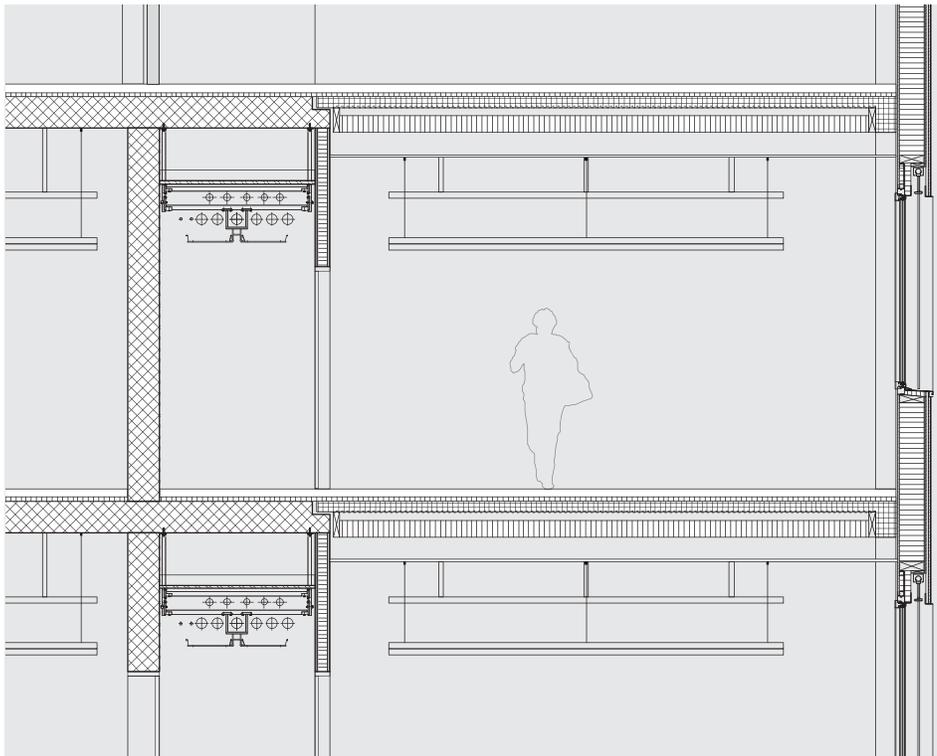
Konstruktionsschnitt eines Laborgebäudes in Neuenburg mit vorgefertigten Holz-Beton-Verbundelementen für die Geschossdecken sowie vorgefertigte Fassadenelemente aus Holz, hinterlüftet und mit Keramikplatten verkleidet.
